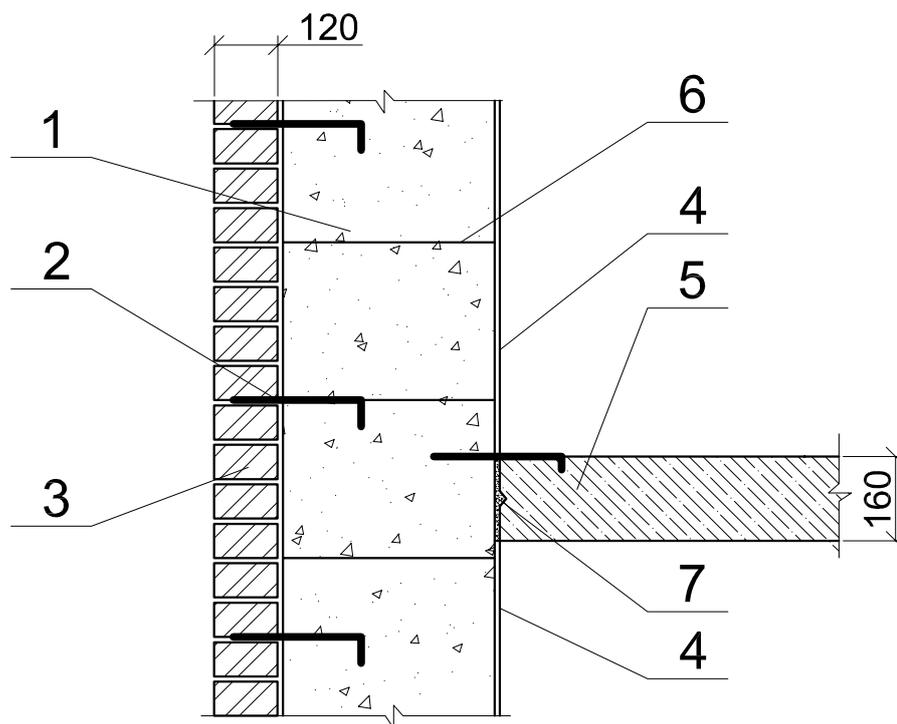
Несущая стена из газобетонных блоков ГРАС и самонесущей кирпичной облицовки
